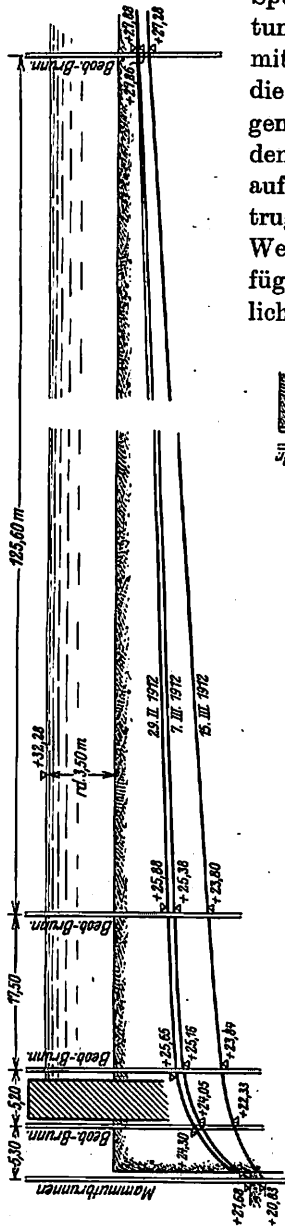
Spreetunnel Inselbrücke (Abschnitt II); beobachtete Spiegelsenkung vor Kopf (nach Enzweiler).
